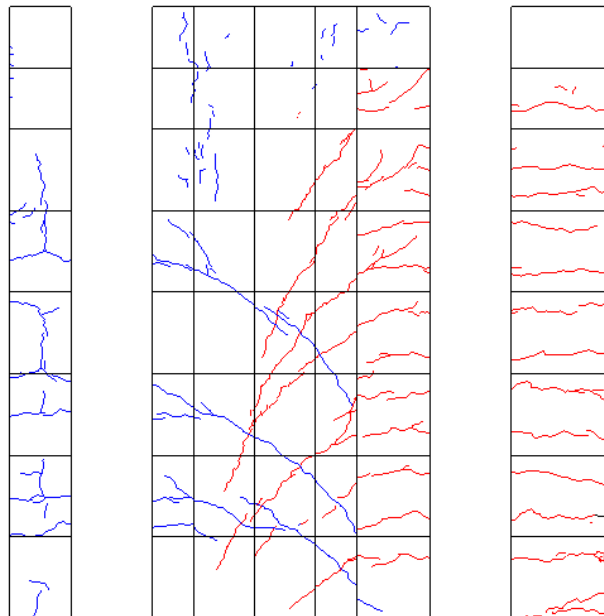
R=1/133 ひび割れ図
